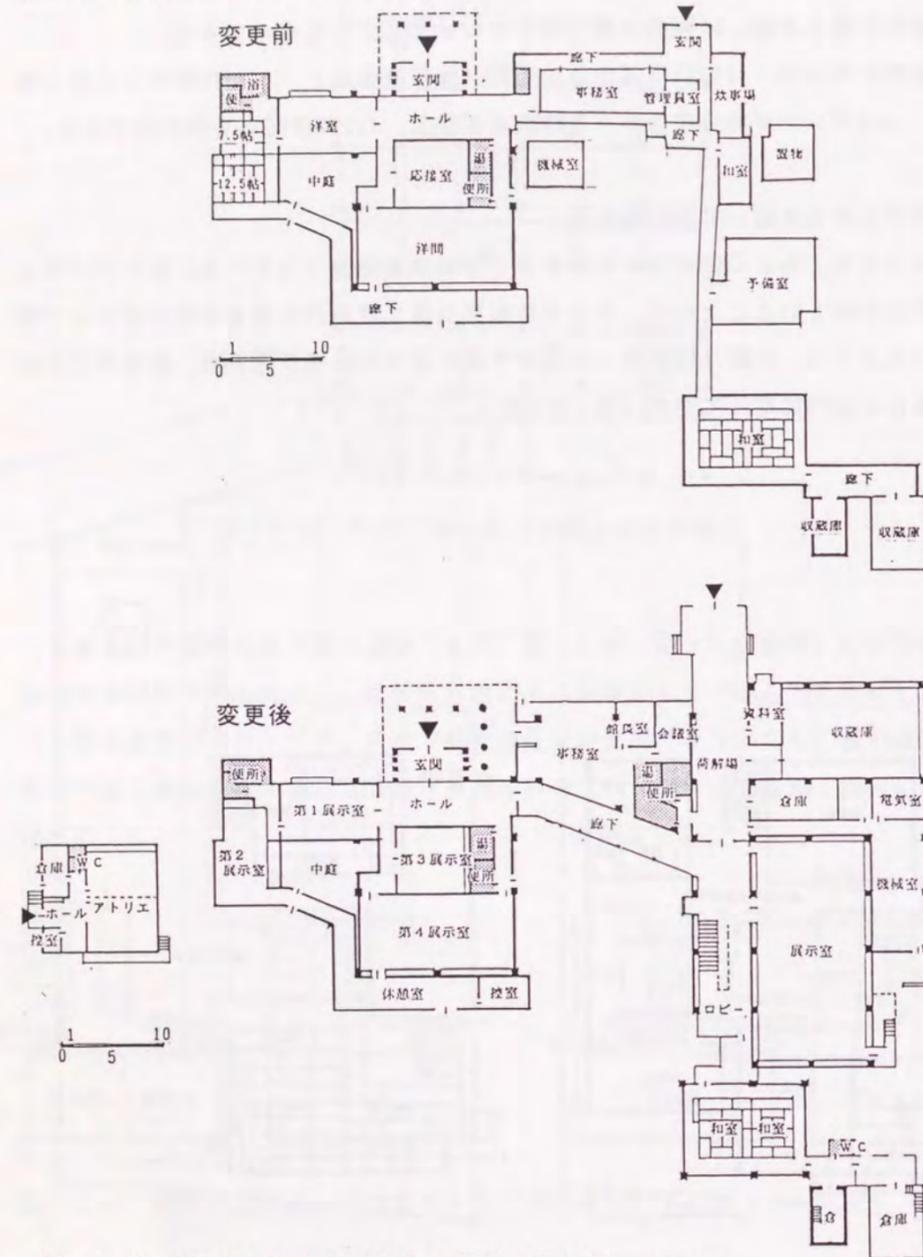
<115>西宮市大谷記念美術館(旧邸宅)平面図
